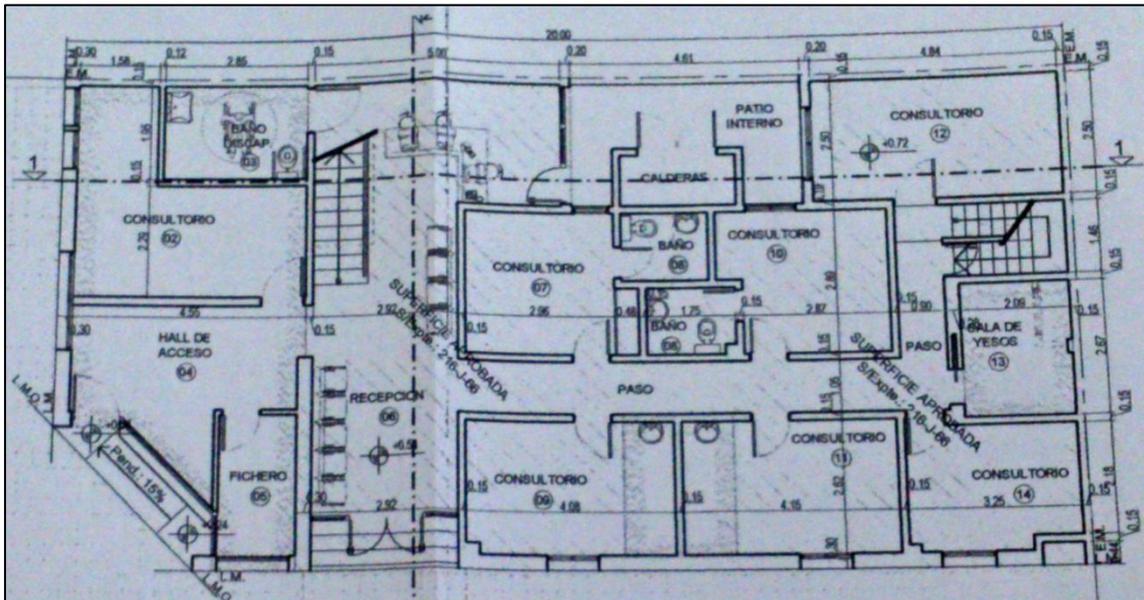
LAY OUT ACTUAL CE, PLANTA BAJA.
